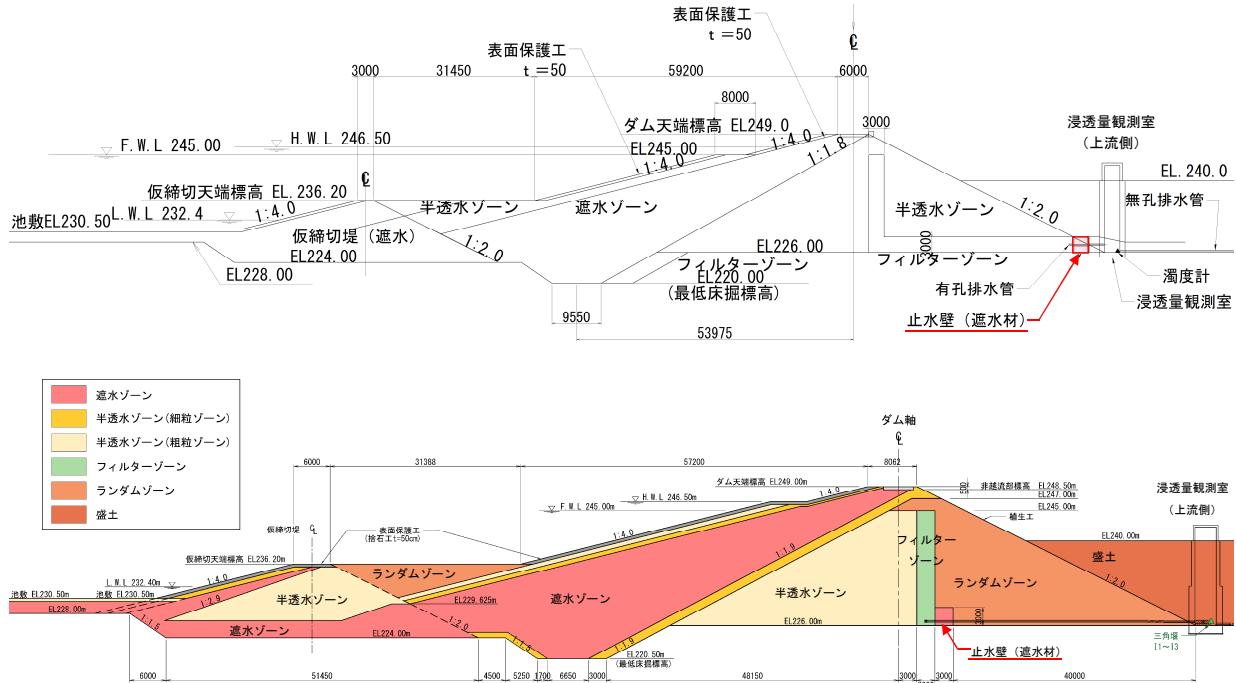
大切畠ダムの標準断面図（上：設計当初の断面図、下：現在の標準断面図）
